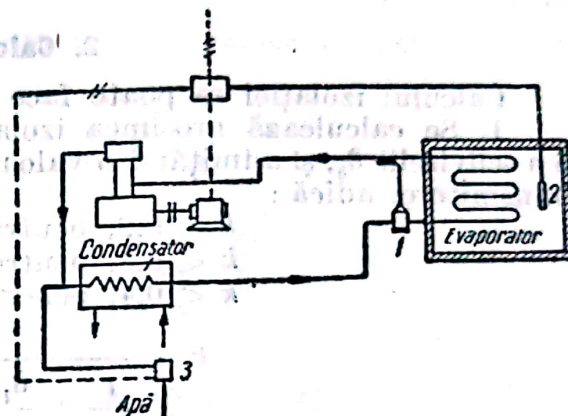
Schema unei instalații frigorifere cu valvă termostatică:
